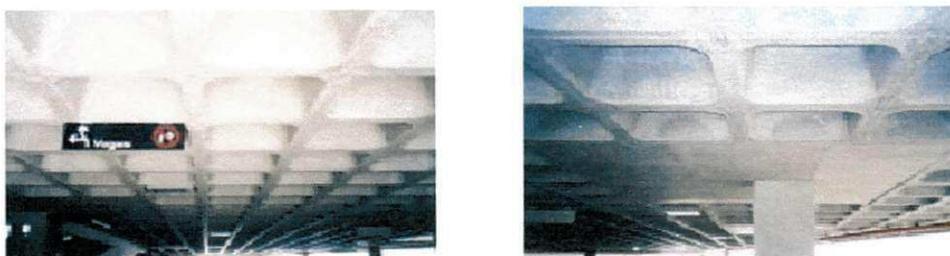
a e 7.2.3.b Laje nervurada de um edifício garagem (cortesia Atex)
